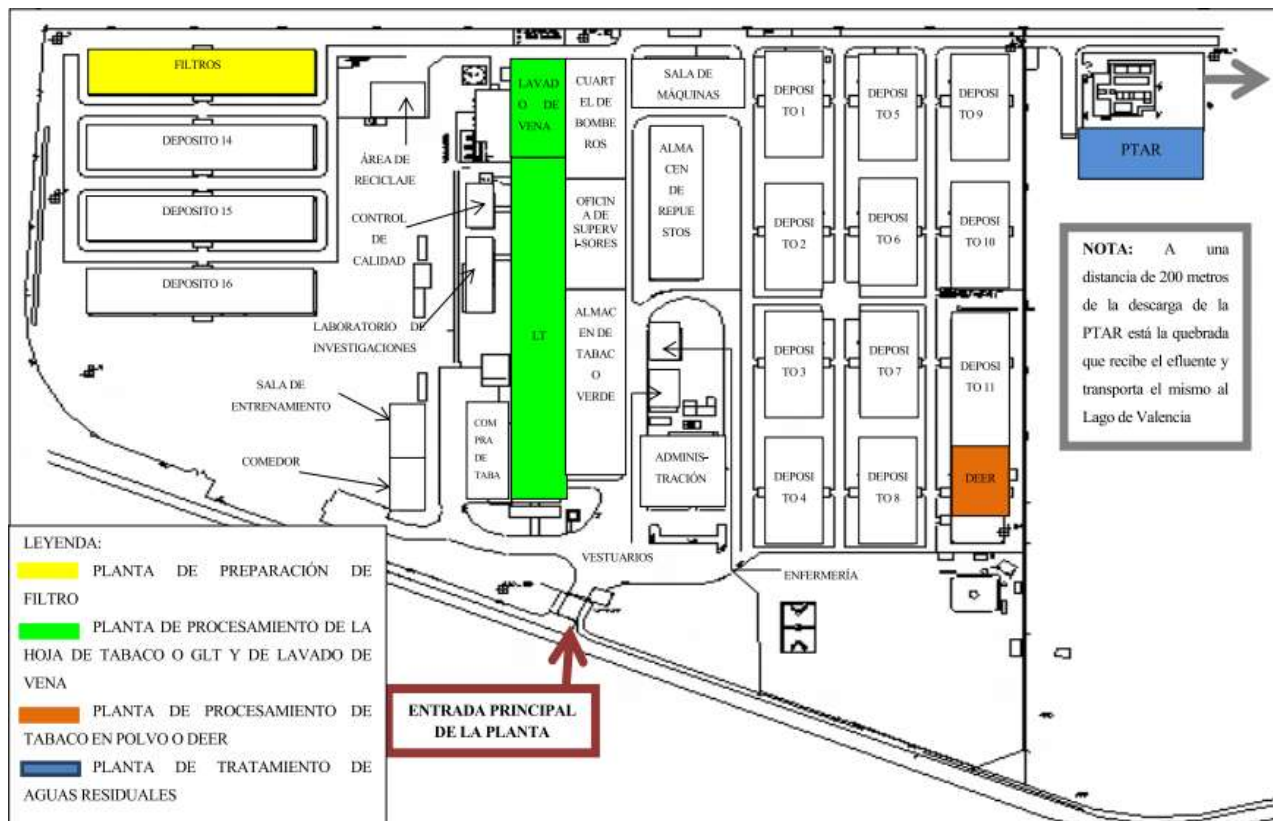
Plano General de C.A Cigarrera Bigott Suc. Planta Valencia
